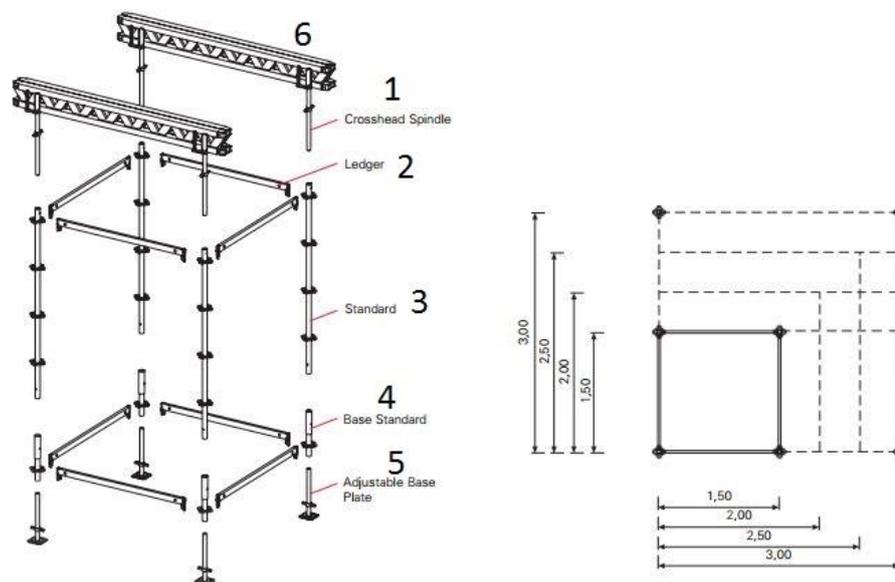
A la izda. detalle de elementos del sistema y configuración de torre de carga sin diagonales. A la derecha modulaje para emparrillado de base.
